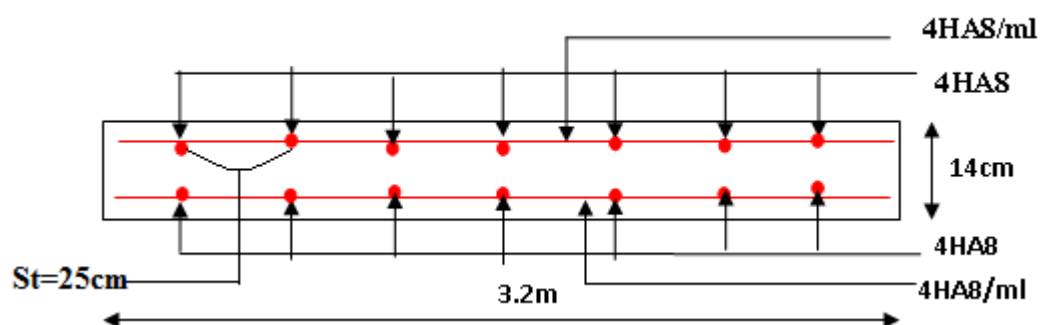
Schéma de ferrailage de la dalle sur quatre appuis
